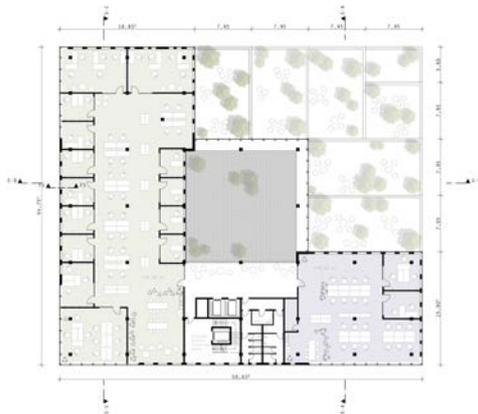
Grundriss 18.-20.Obergeschoss
